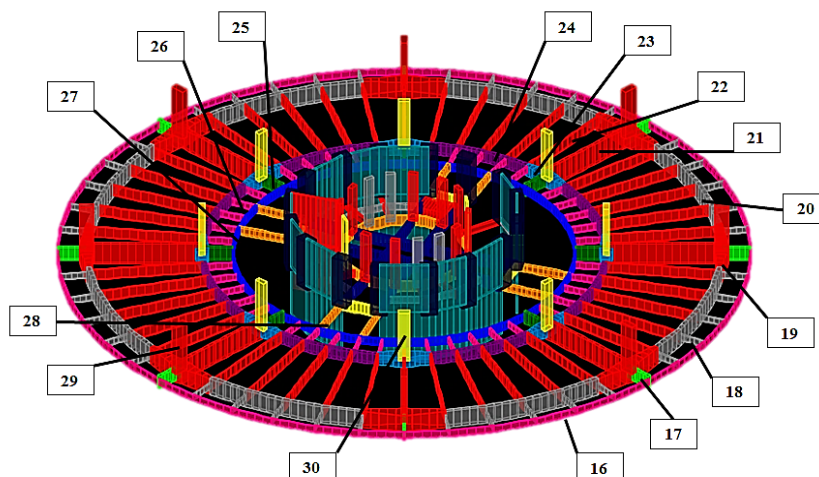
Elementos estruturais do pavimento tipo modelados, bloco A; Fonte: os autores
